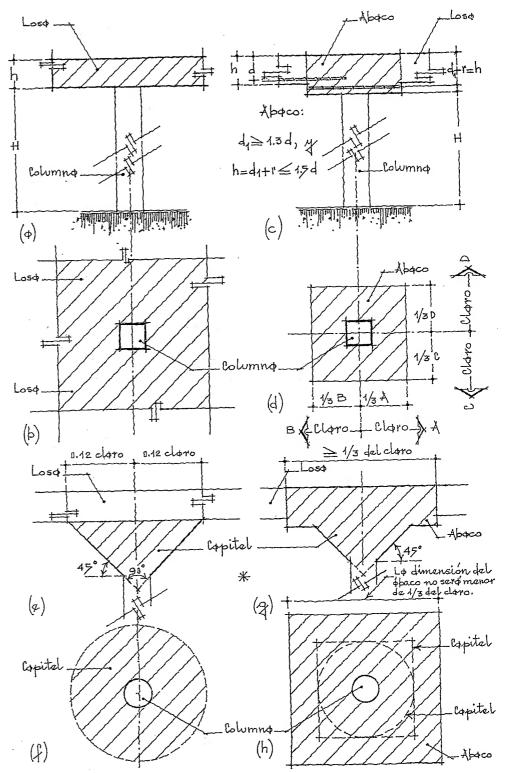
Lost apoyado directamente sobrelo columno, (4). Fig. 16.14. Plonto, (b).
